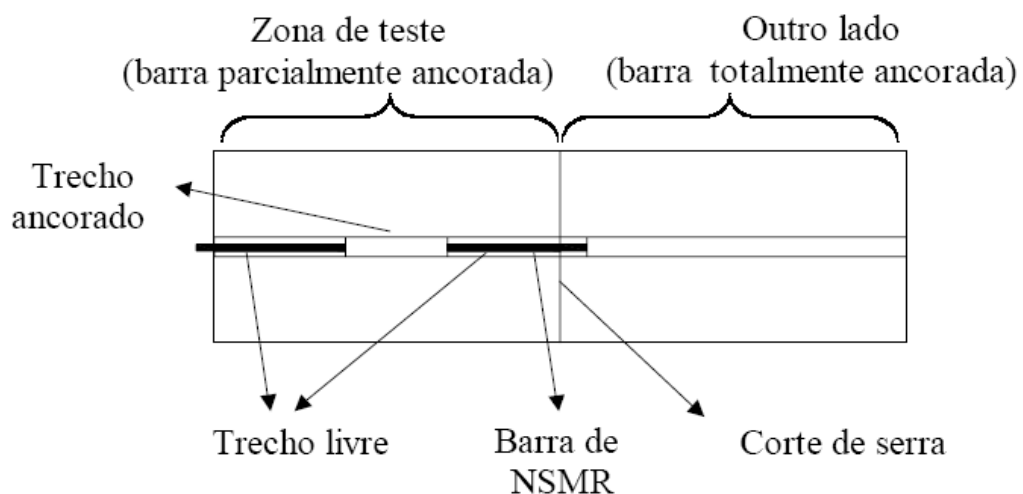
Detalhe da ancoragem da barra no ensaio, face inferior da viga (De Lorenzis & Nanni, 2002, com adaptações)
